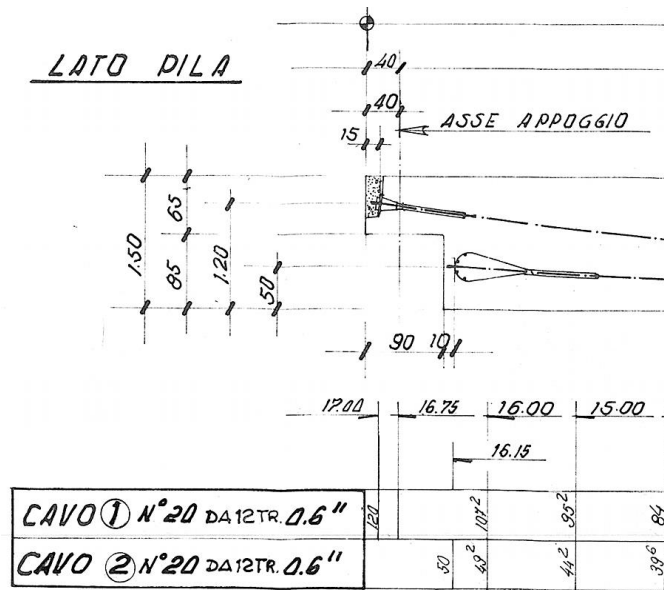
Sezione Longitudinale,, andamento dei cavi da precompressione
